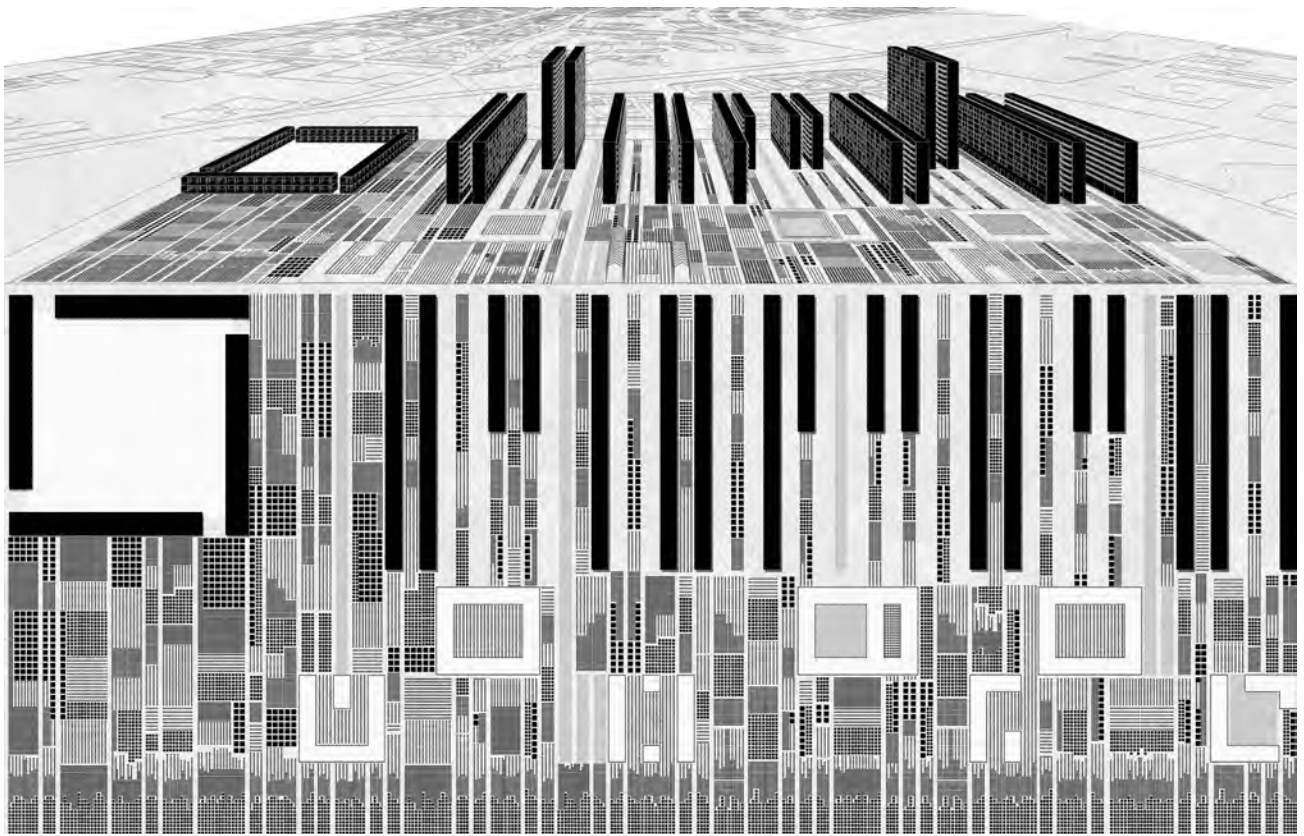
Planivolumetrico e vista prospettica del progetto.
